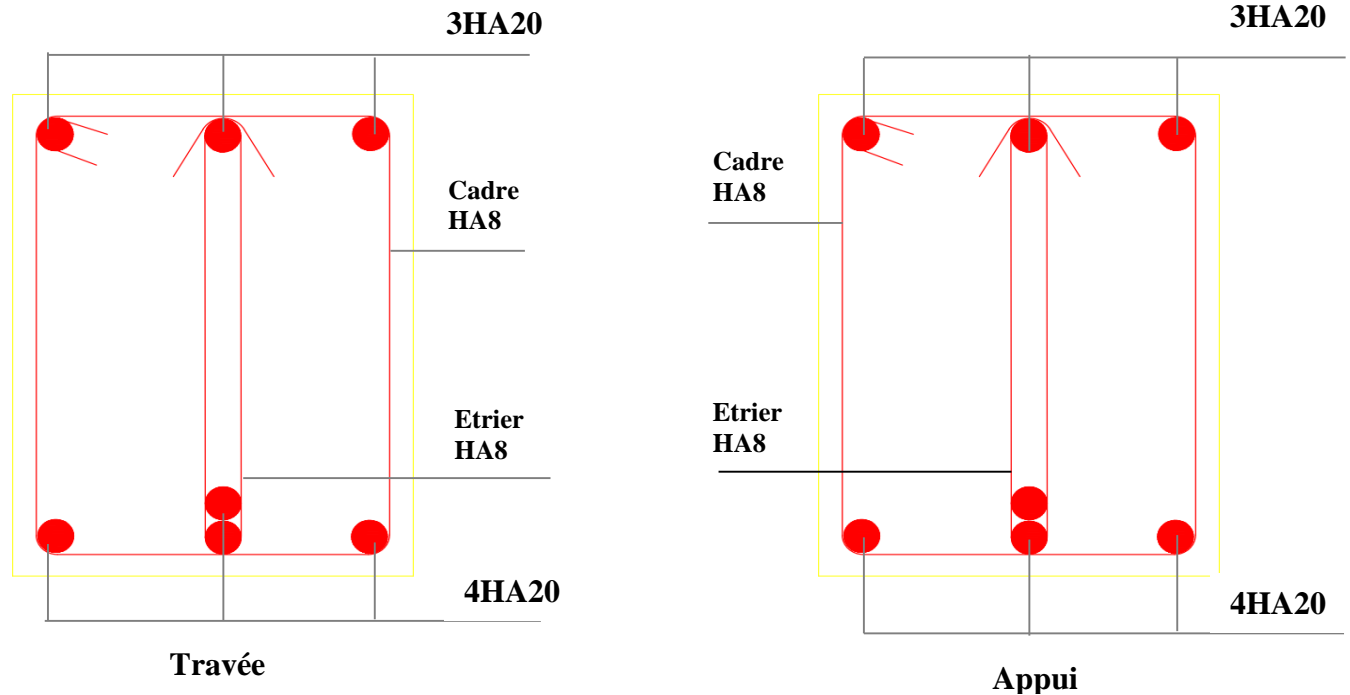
Schéma de ferrailage poutres secondaires étages 1,2,3
